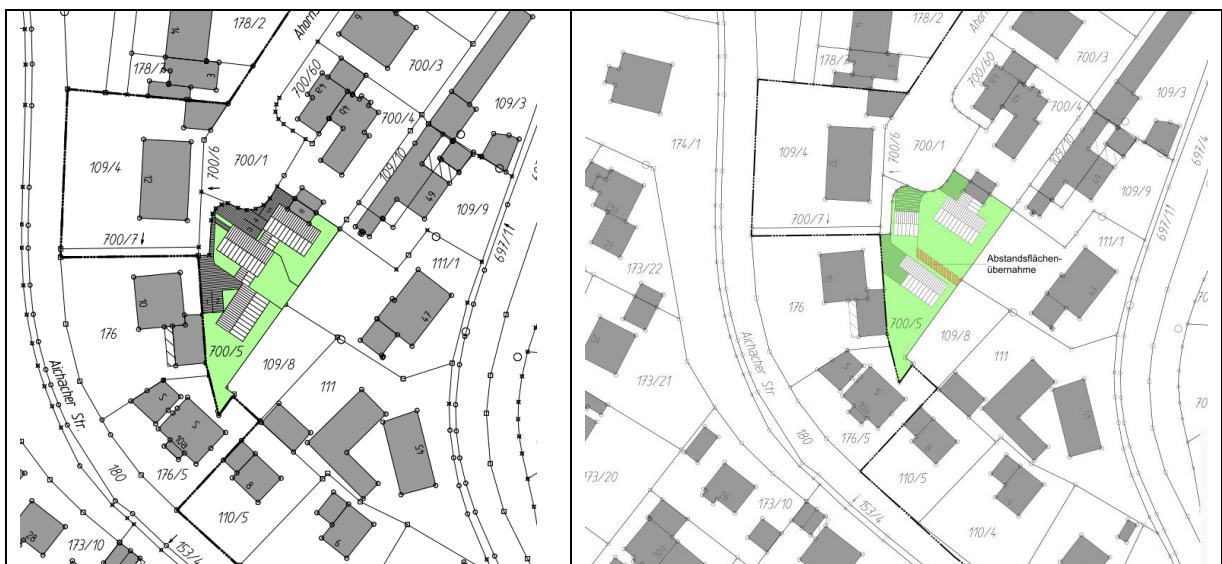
Alternative Bebauungsvorschläge mit kleinteiliger Bebauung (WipflerPlan, Mai 2017), links: Aufteilung in 3 Grundstücke rechts: Aufteilung in 2 Grundstücke
